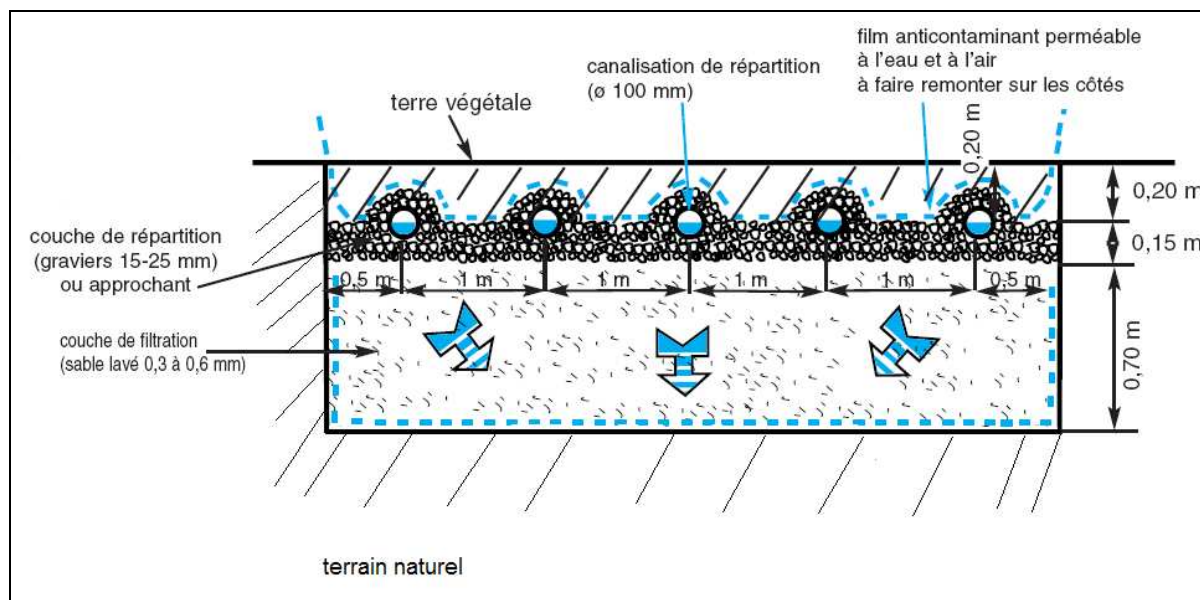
Coupe transversale d'un filtre à sable vertical non drainé
